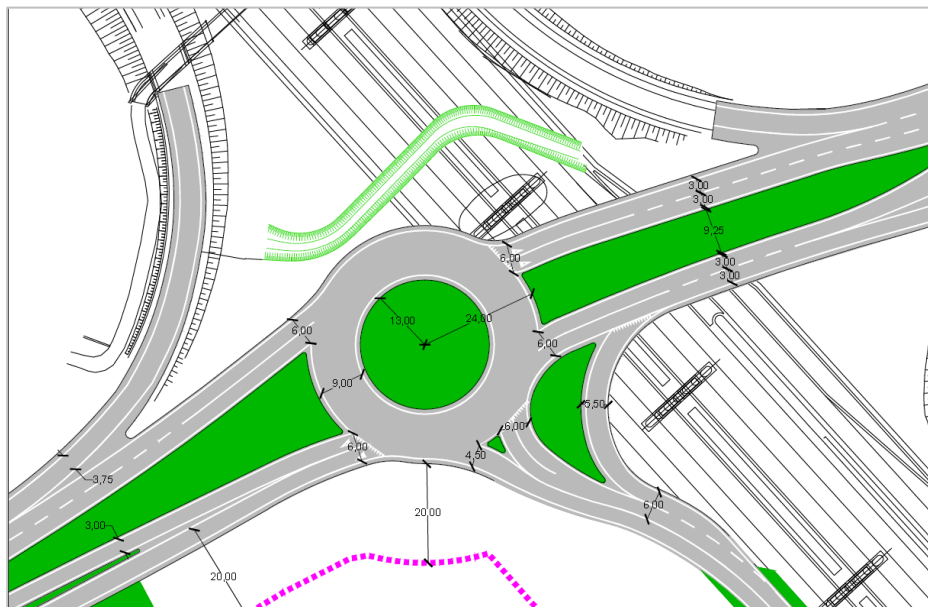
Rotatoria lungo via San Marco – Ipotesi 1 – Planimetria di progetto
